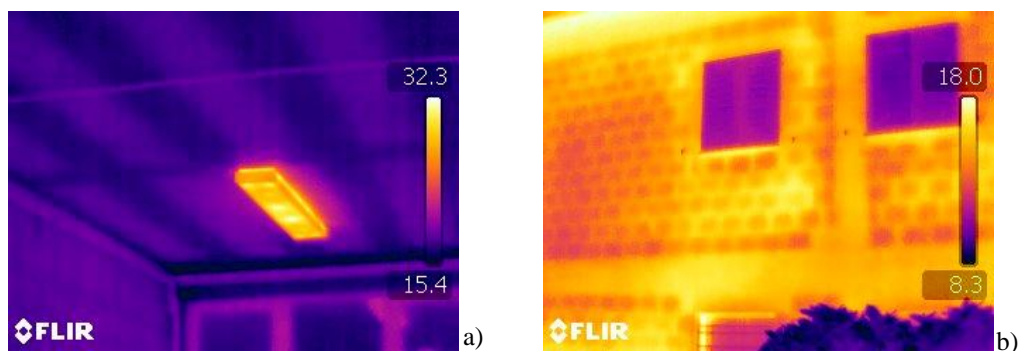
Ausência de isolamento: a) Teto com laje de vigotas; b) Paredes de alvenaria
